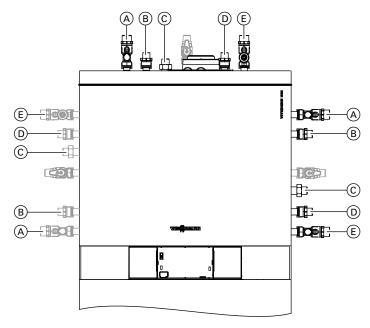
Illustration avec ensembles de raccordement pour montage non encastré (accessoires)
